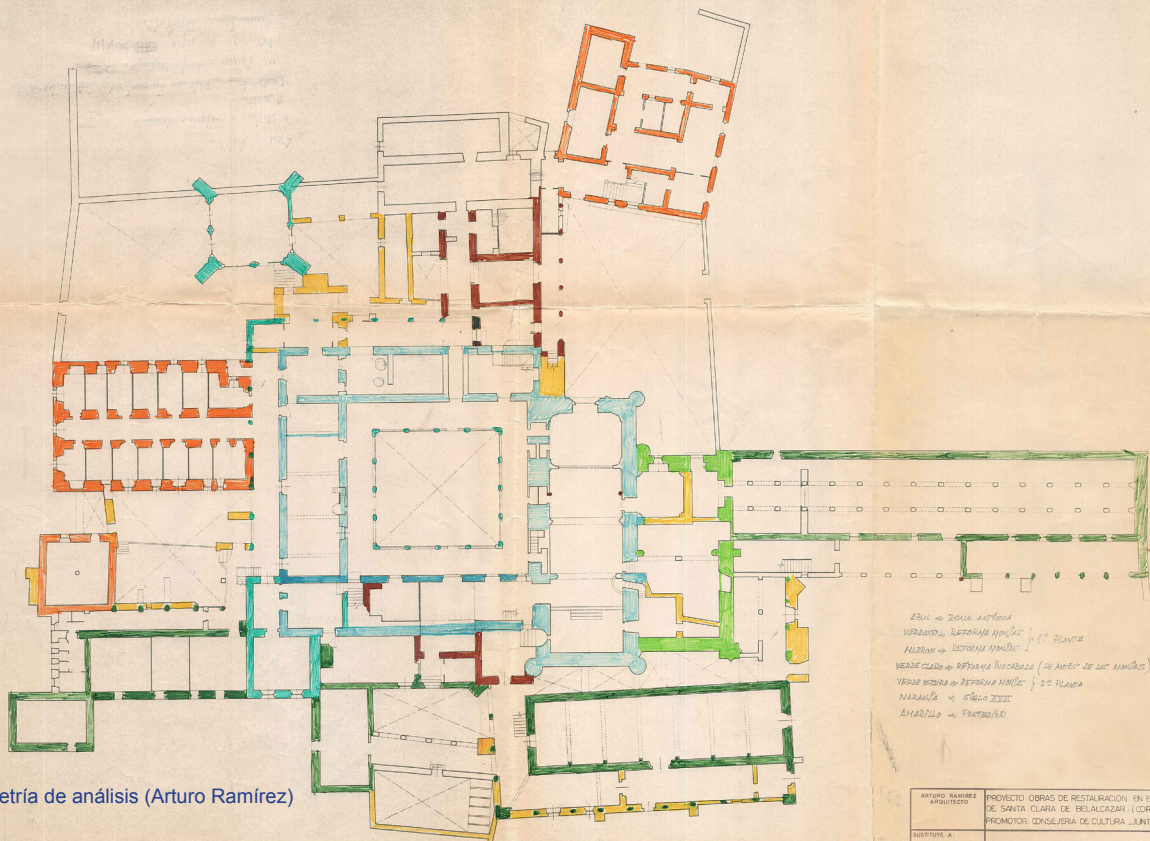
| Planimetría de análisis (Arturo Ramírez)
